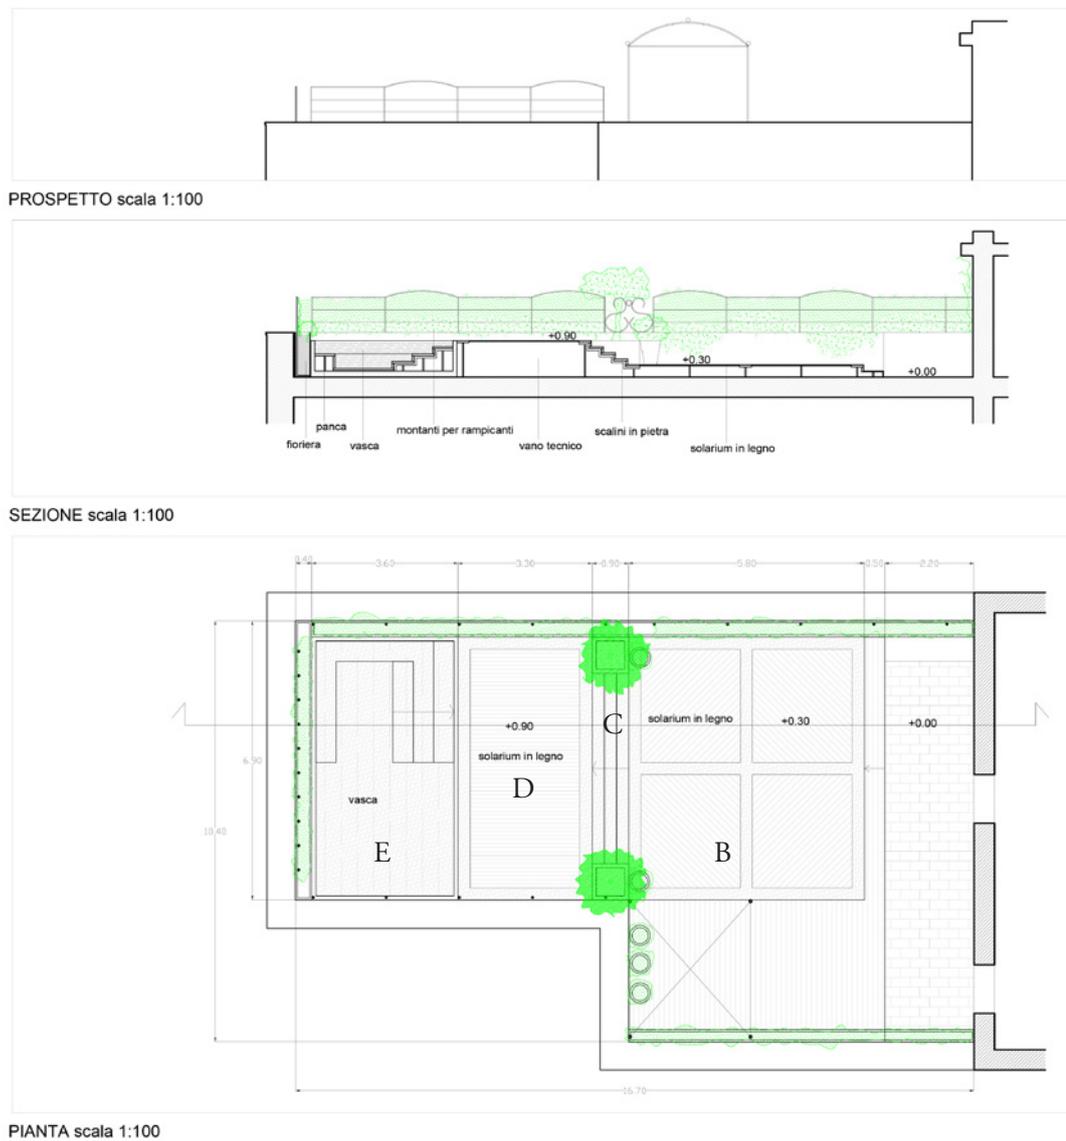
Planimetria e sezione per una terrazza ad Alassio (SV).
